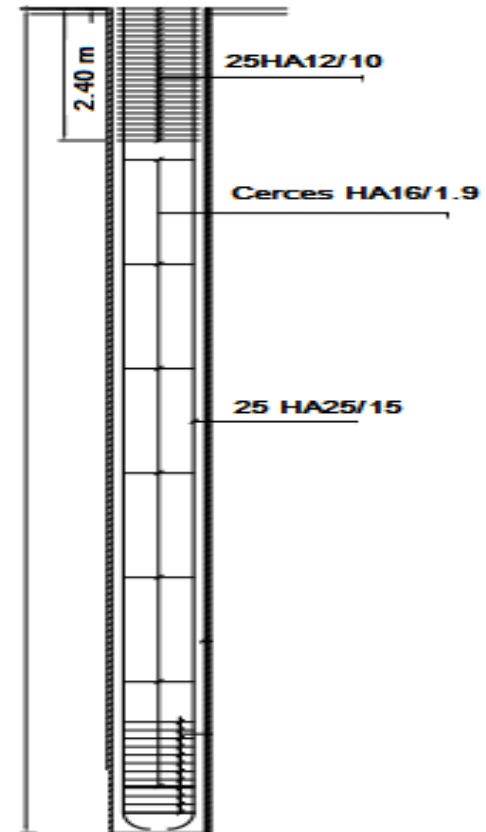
Coupe 2 sur le plan de ferrailage du PIEU
